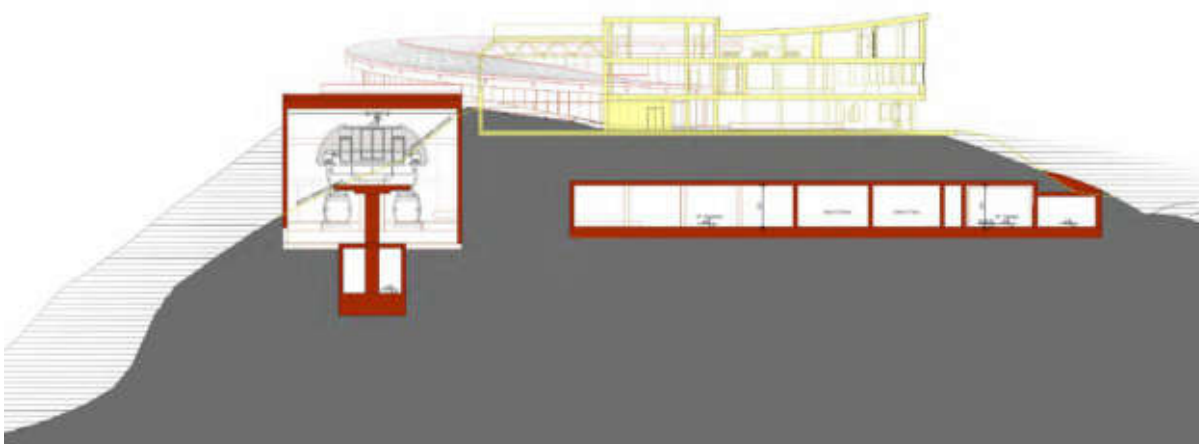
Projektauszug –Schnitt EE – GR -M Bergstation (Arch. Sader) / stralcio da progetto – sezione EE – GR -M stazione di monte (Arch. Sader)
